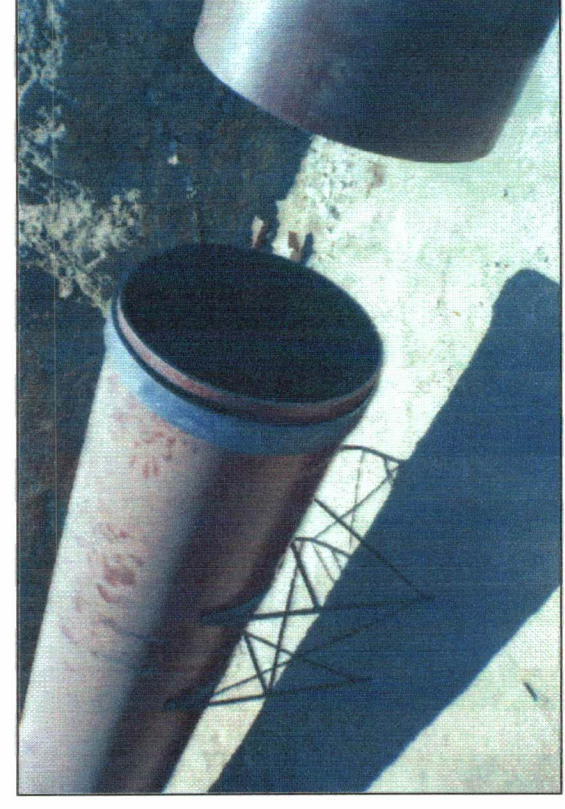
Detalhe do anel que será soldado nas junções do tubo.
